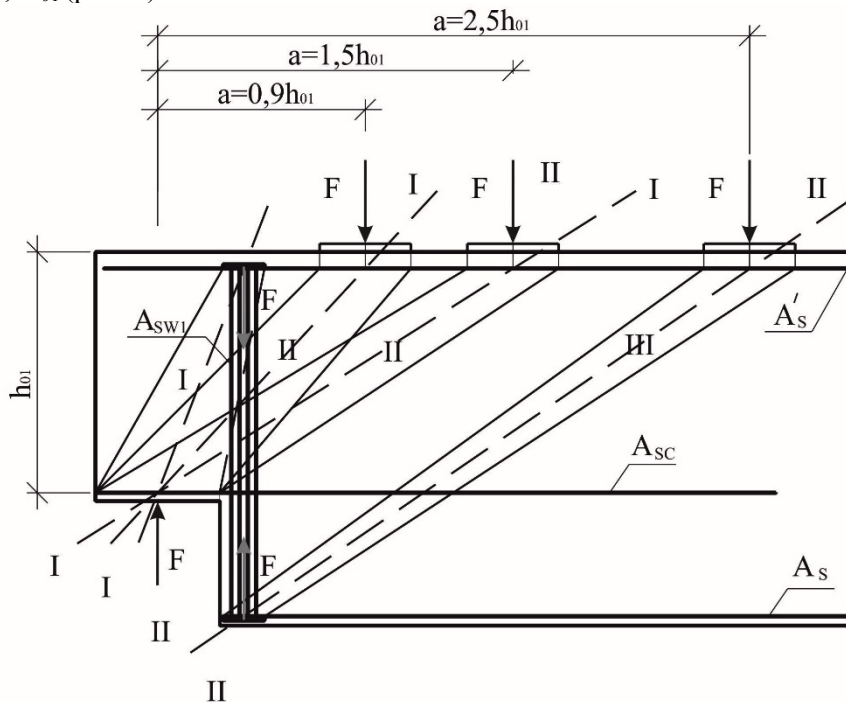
Схемы сжатых полос бетона между физическими и условными грузовыми и опорными площадками:
